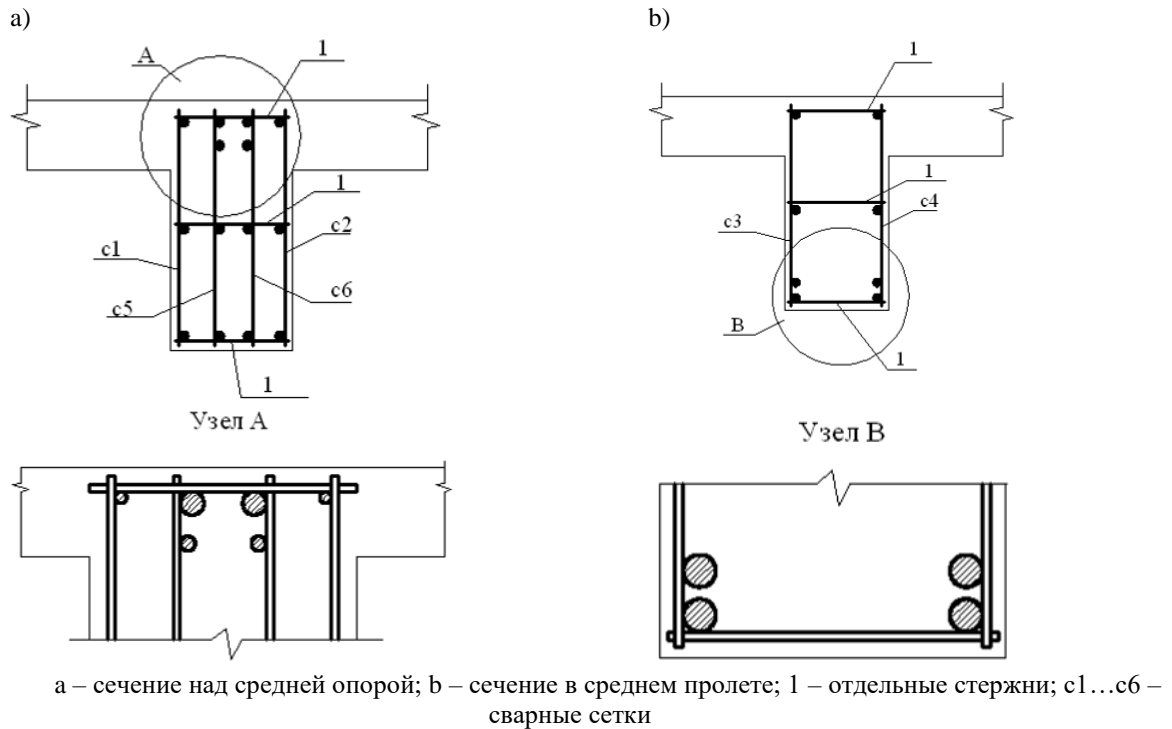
Фрагменты армирования монолитной балки сварными сетками
